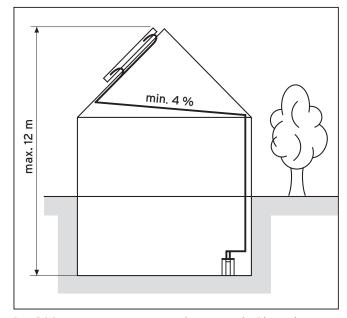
Высота монтажа и уклон трубопроводов без "бака обратной линии гелиоустановки"
